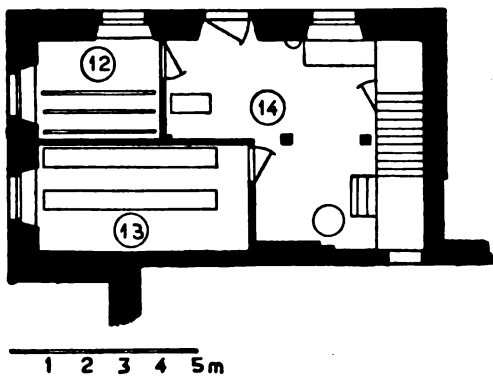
Grundriß des Instituts im Erdgeschoß.
